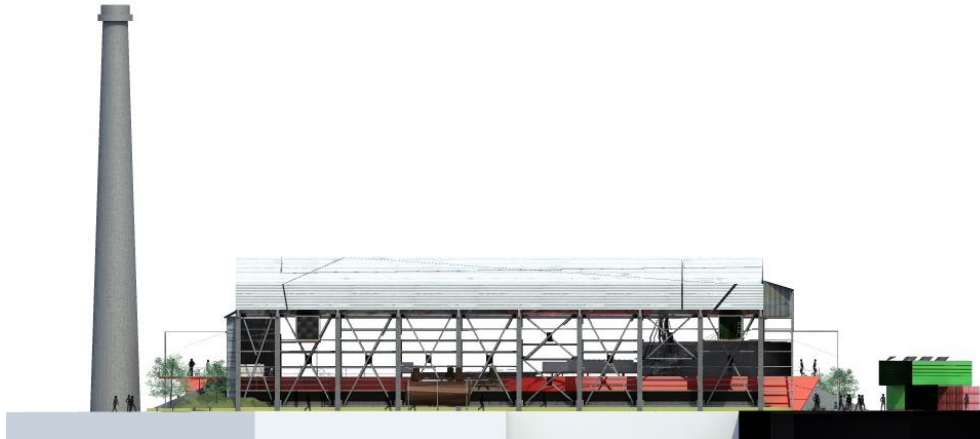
Fachada sur, en donde sobresalen los containers suspendidos. También se aprecian las aberturas en cubierta.
